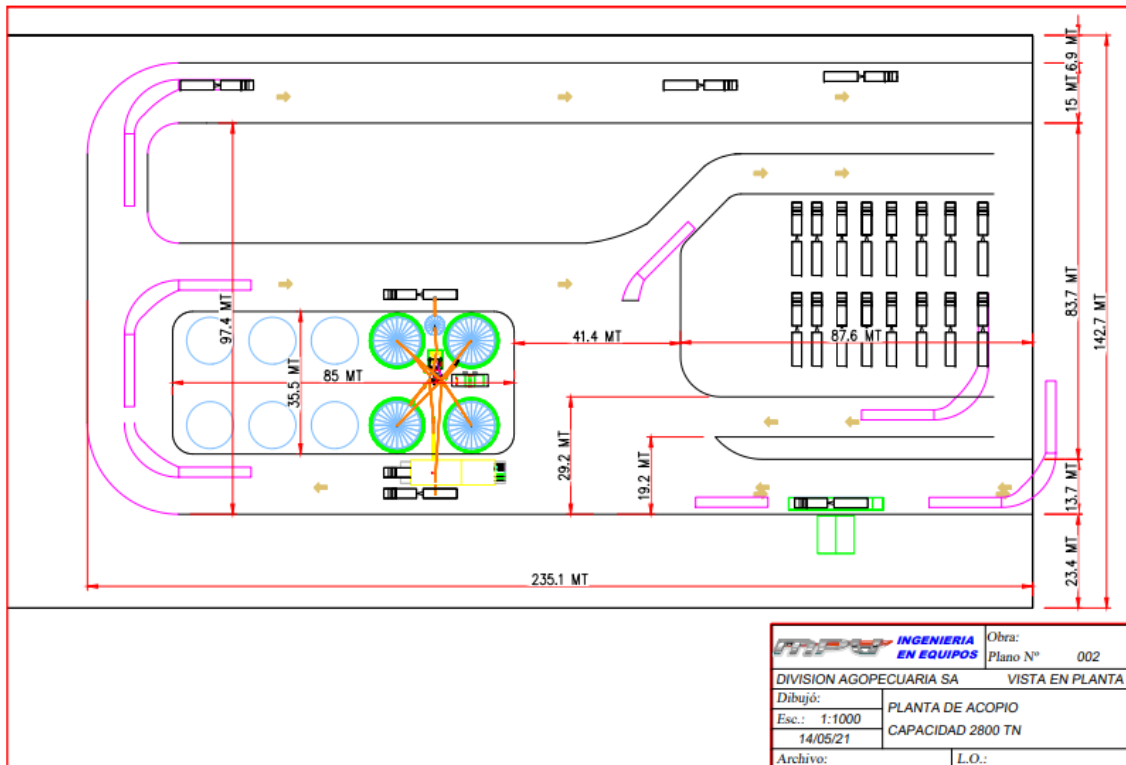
PLANO GENERAL DE LA PLANTA DE SILOS DE ACOPIO.
